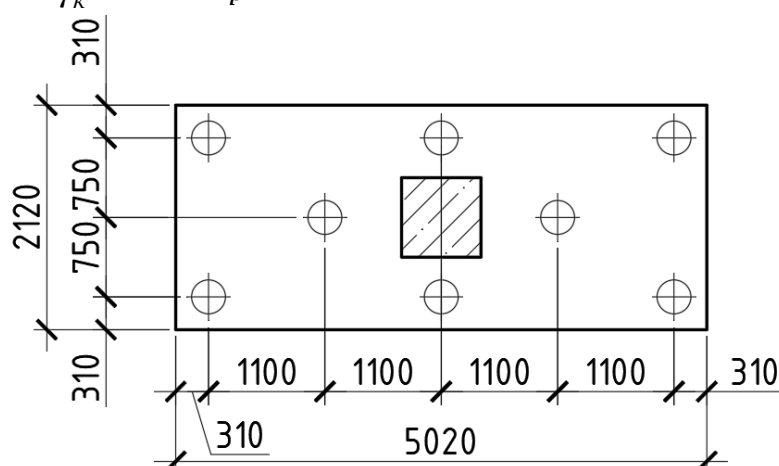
Схема расположения свай под фрагмент плитного фундамента
